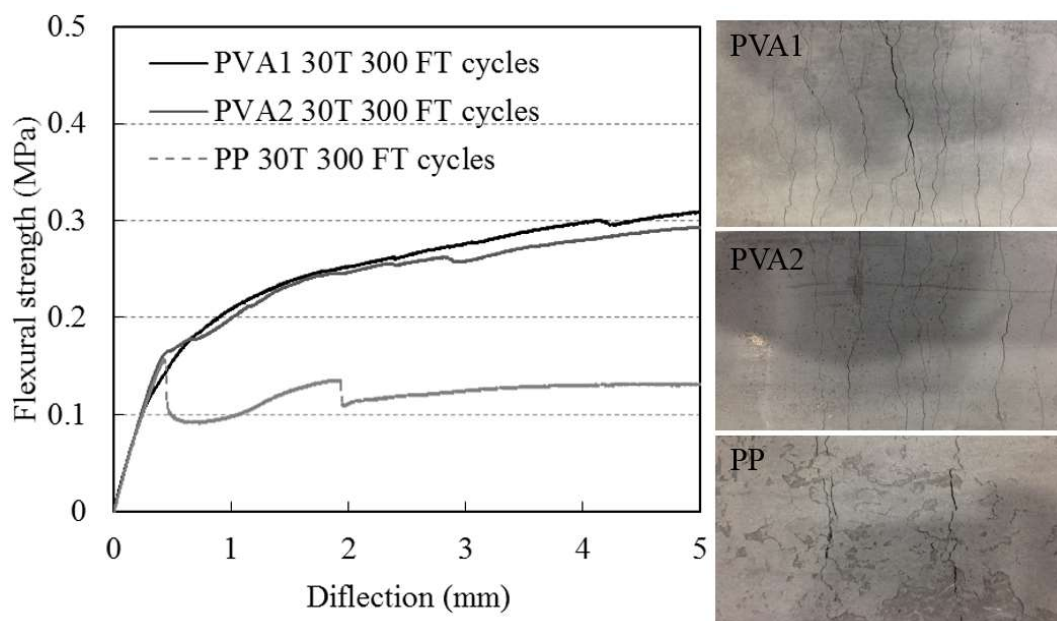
FRM の曲げ応答およびひび割れ発生状況
